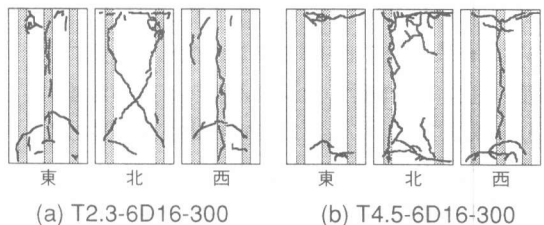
鋼管内部のコンクリートのひび割れ状況
